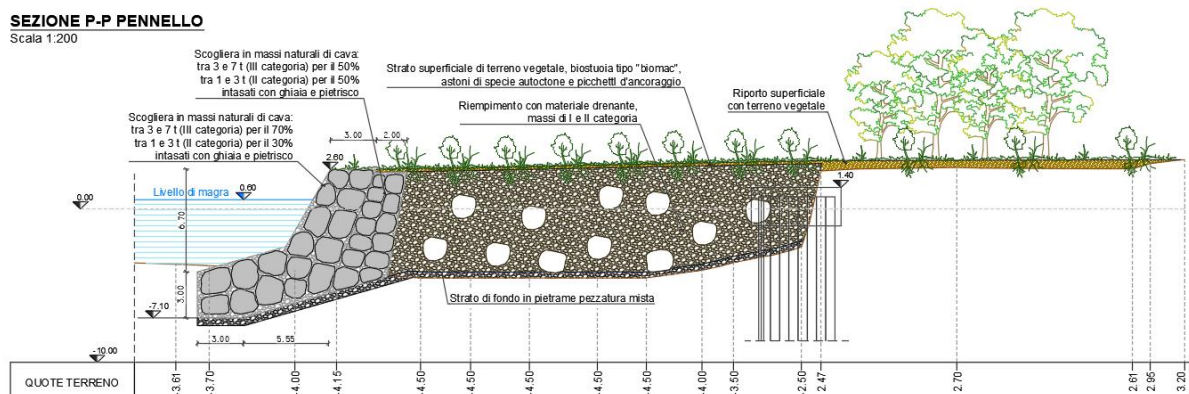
sezione longitudinale intervento di ripristino pennello di protezione
